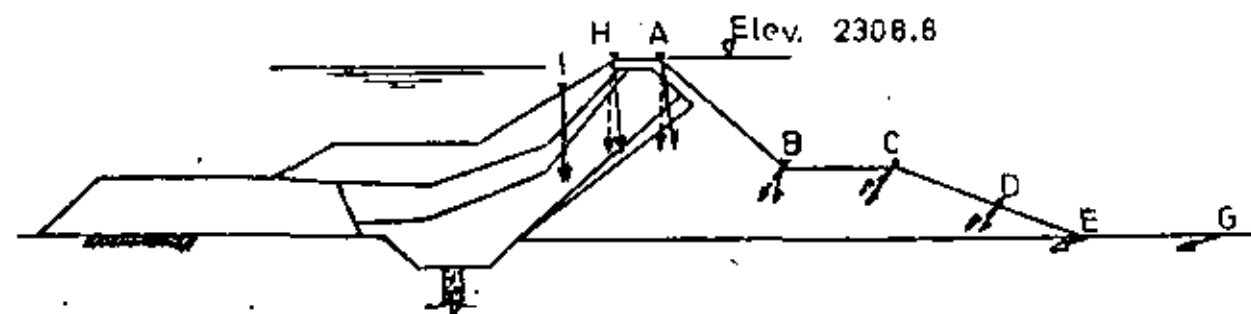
DETALLES DE LA INSTRUMENTACION DE LA PRESA GUADALUPE MEX
